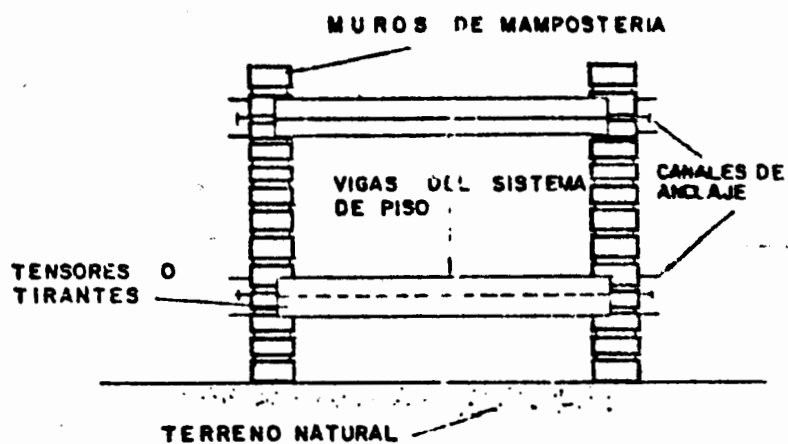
ANCLAJE DE MURO A MURO
